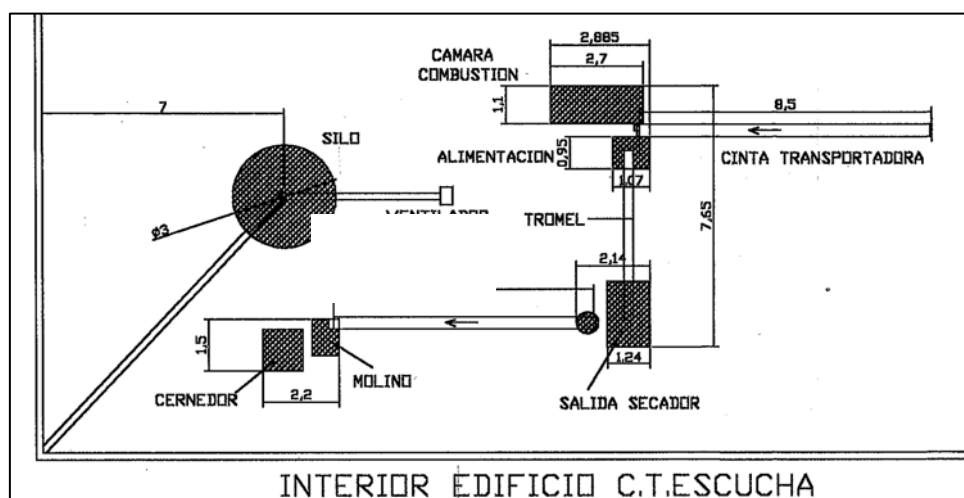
Disposición de equipos de la instalación de pretratamiento y del silo en la planta.
